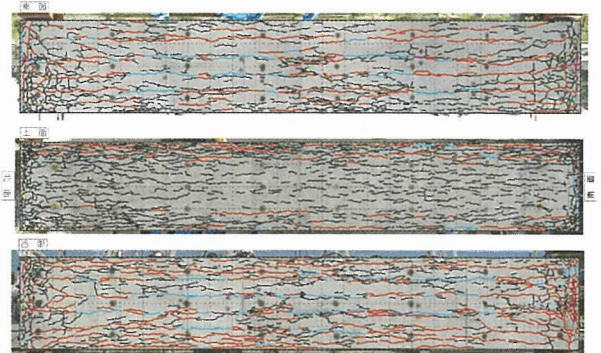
ひび割れ発生状況 (材齢 22 ヶ月)
